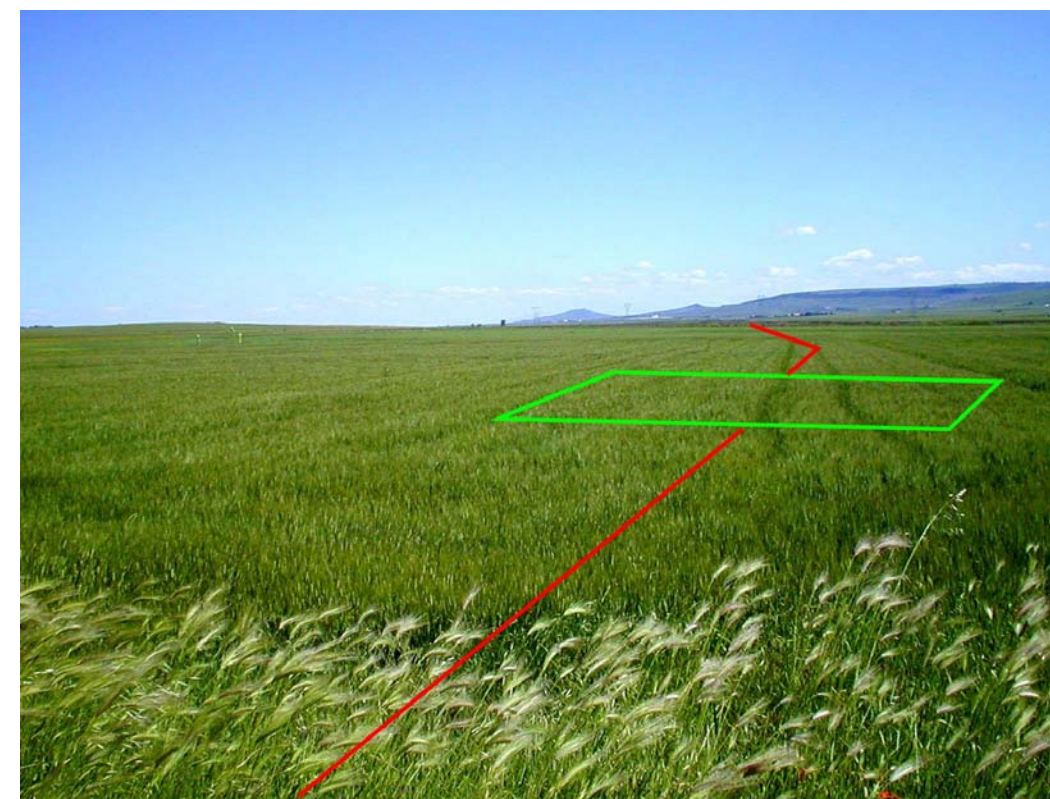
Spinazzola - PIL n. 15 in località Masseria Barbuzzi sud
